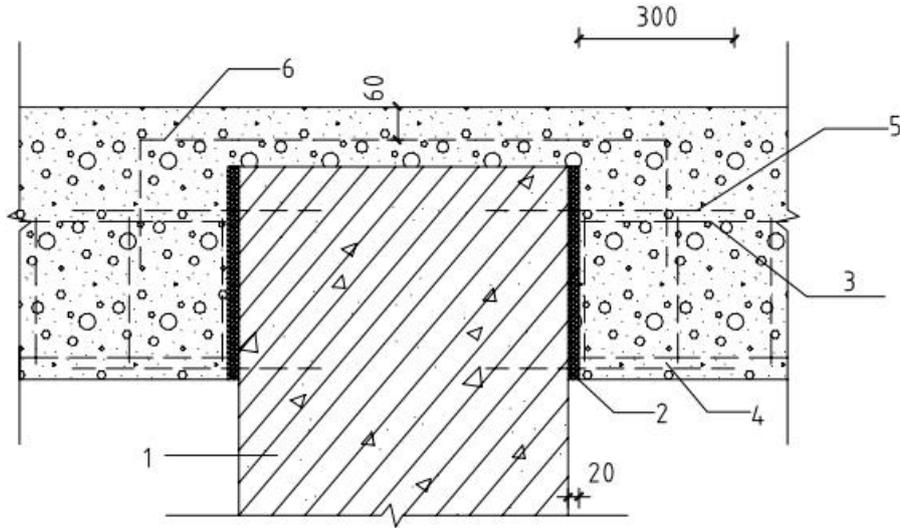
泡沫混凝土墙体与主体结构交接处构造示意
